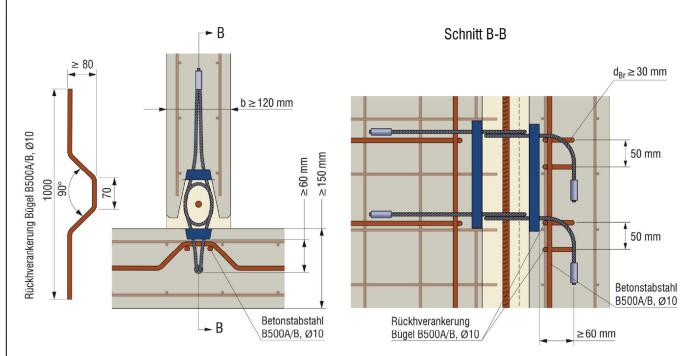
Wand – Wand – T-Verbindung - Detail mit abgewinkelten Seilschlaufen
